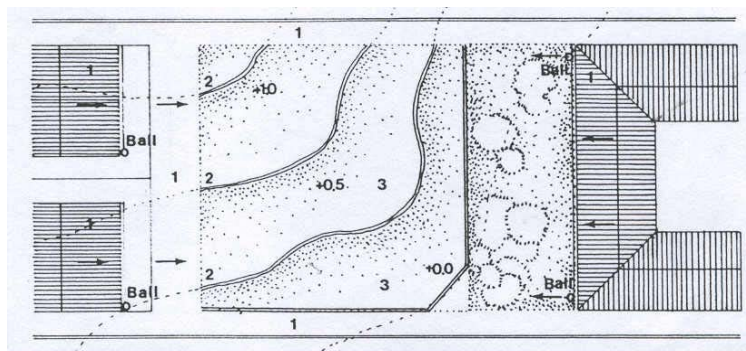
Estanques de infiltración en zonas con pendiente usando solerillas en las curvas de nivel. 1.- Áreas Impermeables, 2.- Solerillas a nivel, 3.- Estanque.
